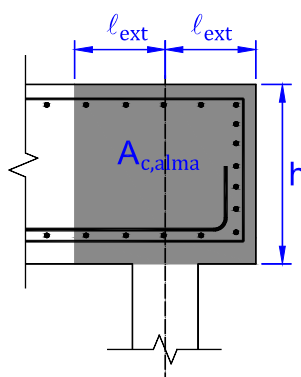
Área de concreto para o cálculo da armadura de pele
